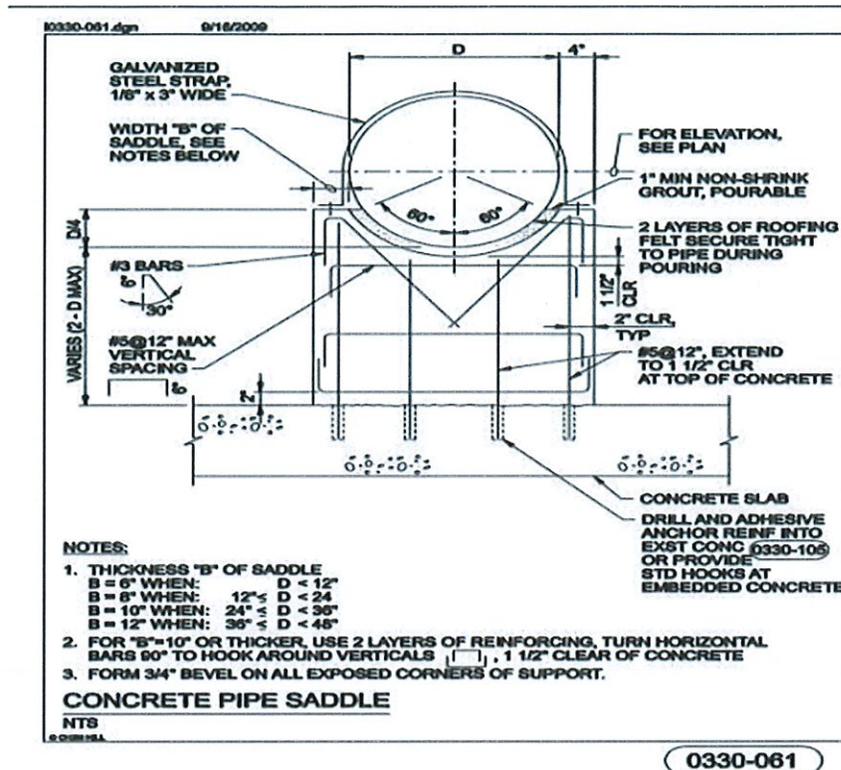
Detalle de construcción de bases de tubería a utilizar:
